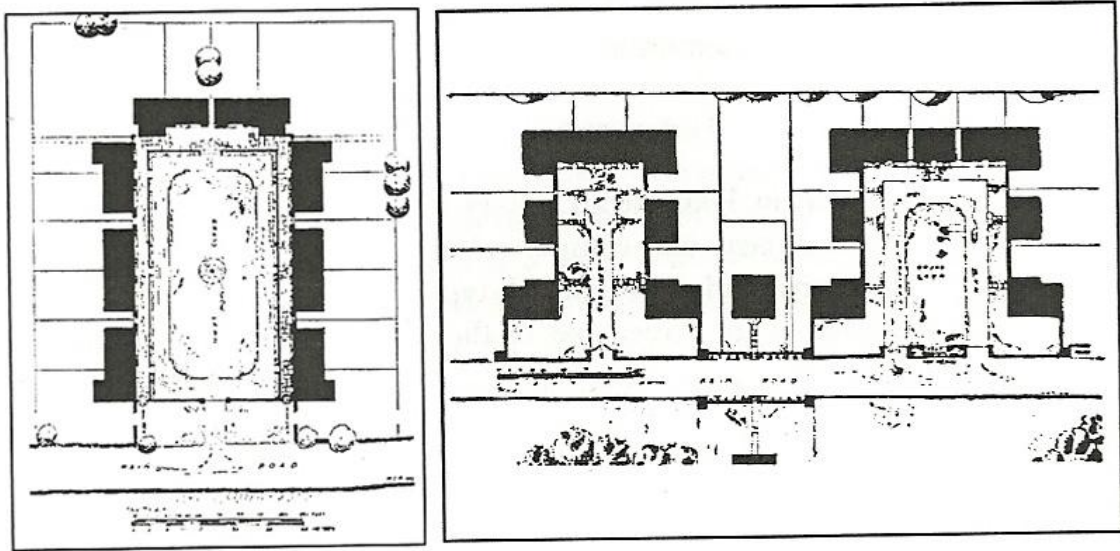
9 Hampstead Bahçe Banliyösü'nün a-1905 yılına ait vaziyet planı, b-1911 yılına ait vaziyet planı [3]
